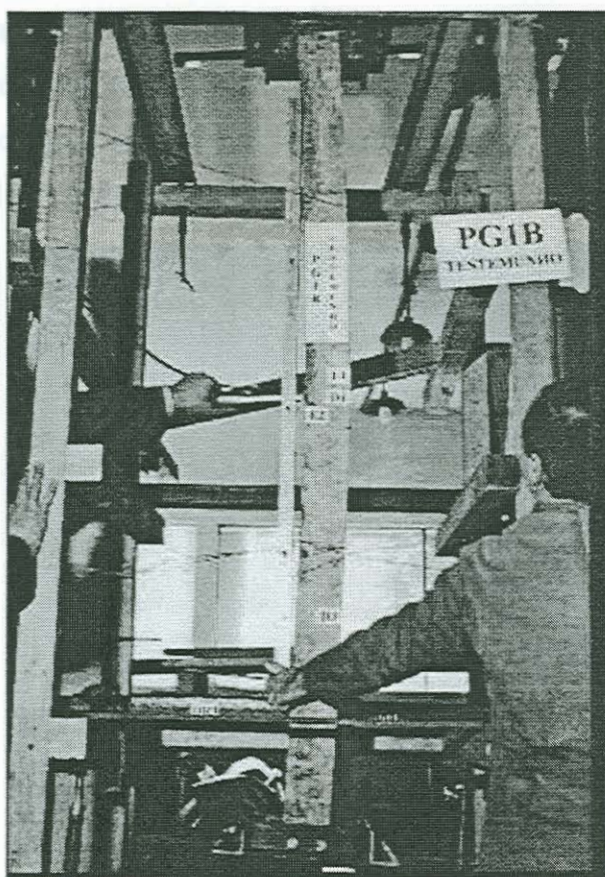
Ensaio do pilar testemunho, flecha apresentada.
